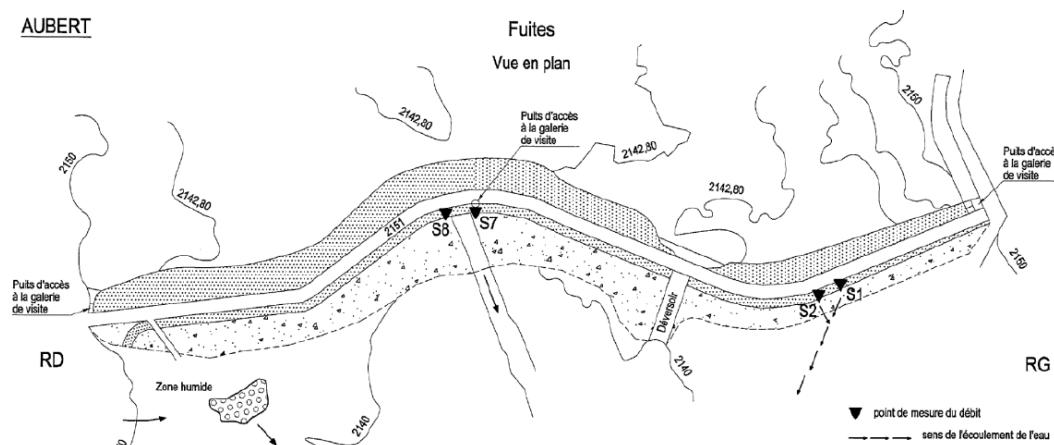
Barrage d'Aubert – Vue en plan (EDF, 2016)
